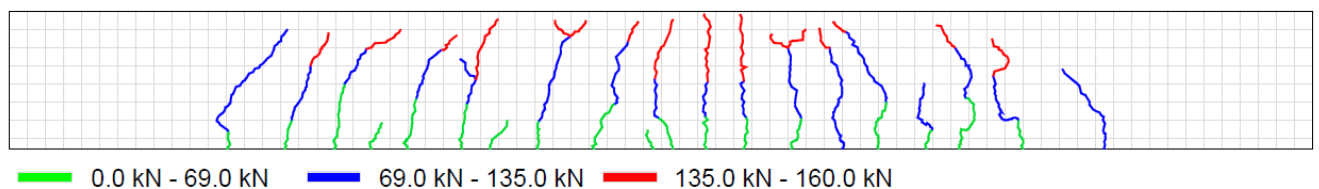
Fisuración y modo de falla de la viga control V1A
